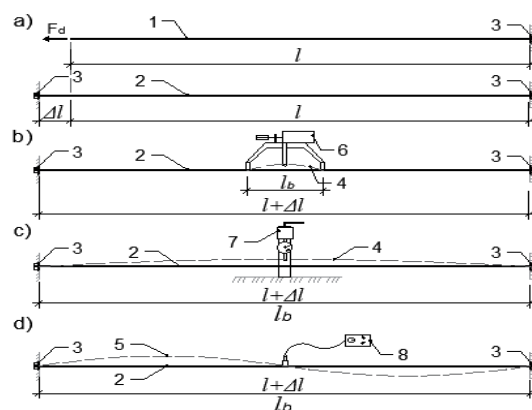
Схеми для вимірювання сили попереднього напруження арматурного елементу методом: а) по величині видовження стержня;
